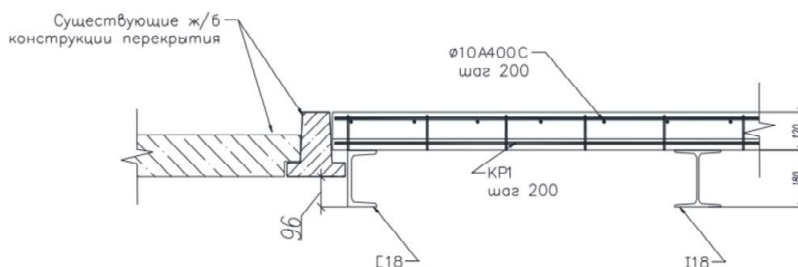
Конструкция монолитного перекрытия с применением стального профилированного настила в качестве несъемной опалубки.
